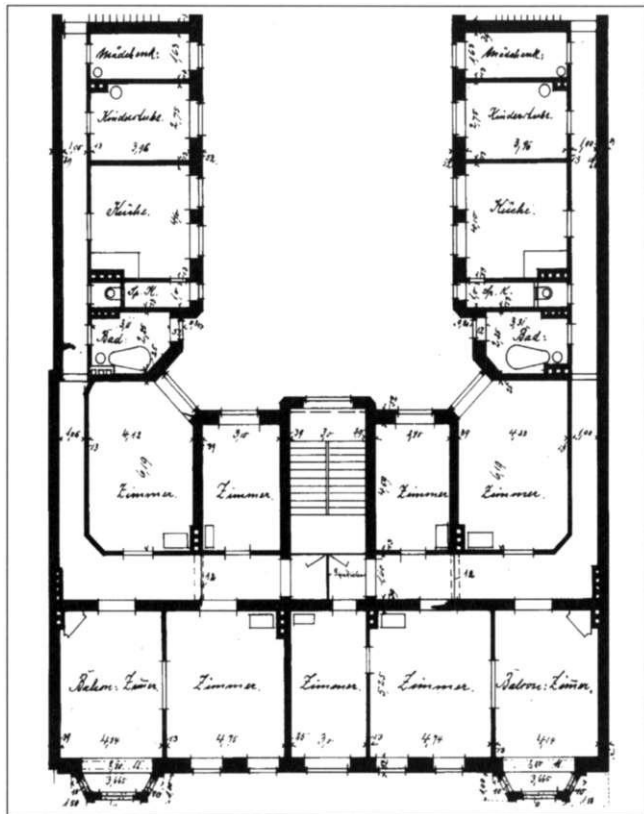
Olvenstedter Straße 12, Obergeschoß, Grundrißtyp E
